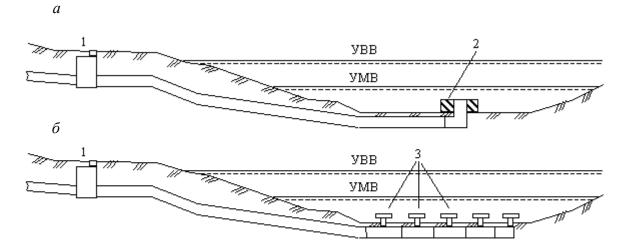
Схемы русловых выпусков a — сосредоточенный; δ — рассеивающий 1 — береговой колодец; 2 — бетонный оголовок; 3 — оголовки с насадками
